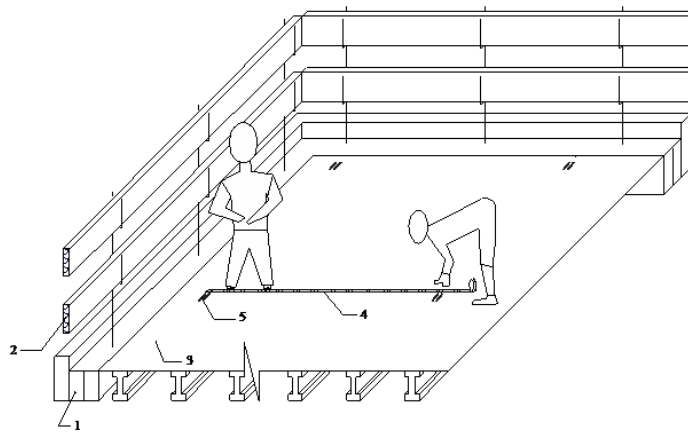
Разбивка палубы при устройстве нижней арматурной сетки: 1 – несущая стена; 2 – инвентарное ограждение; 3 – палуба опалубки перекрытия; 4 – рулетка; 5 – вынесенные на палубу разбивочные оси
